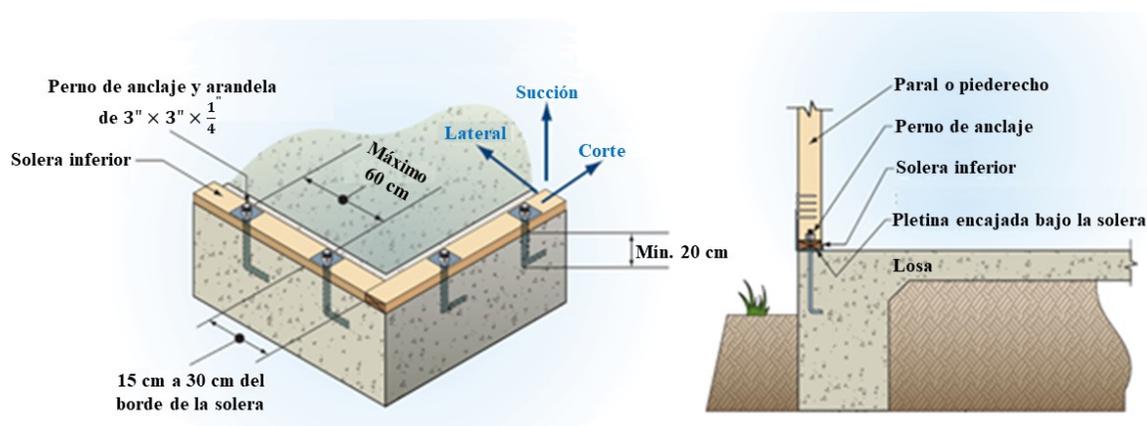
Cimentación en losa flotante. (American Wood Council, 2015)
